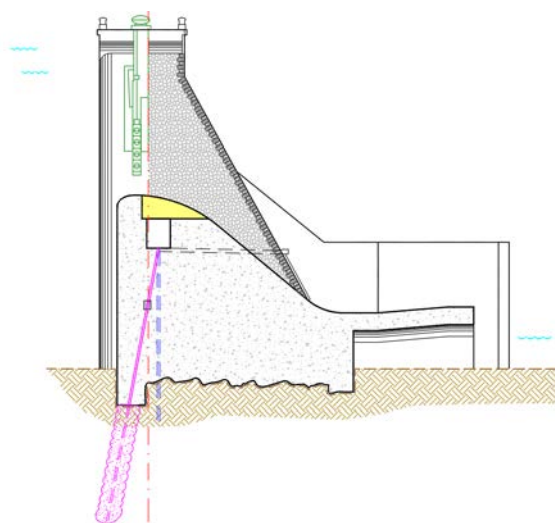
Schermo di iniezione e sistema di drenaggio – Sezione su scarico di fondo
